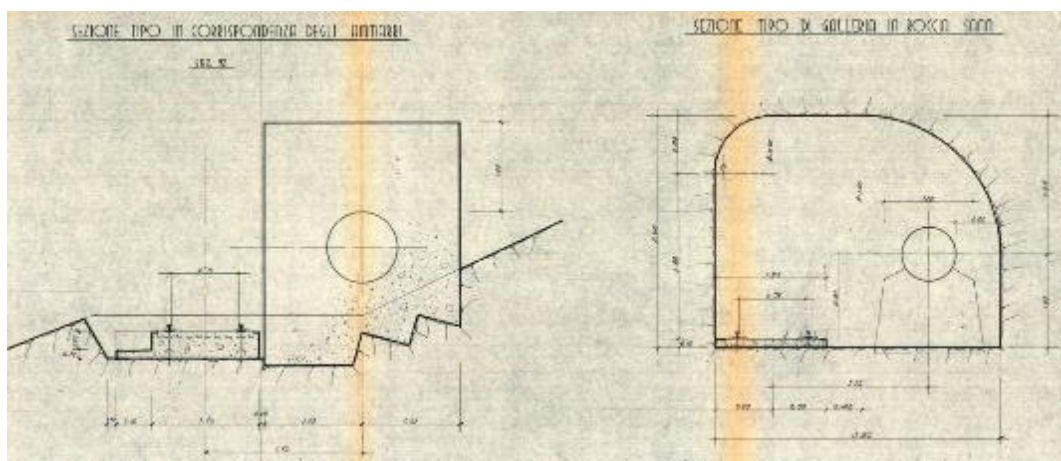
sezione tipo condotta e piano inclinato (anno 1956)
